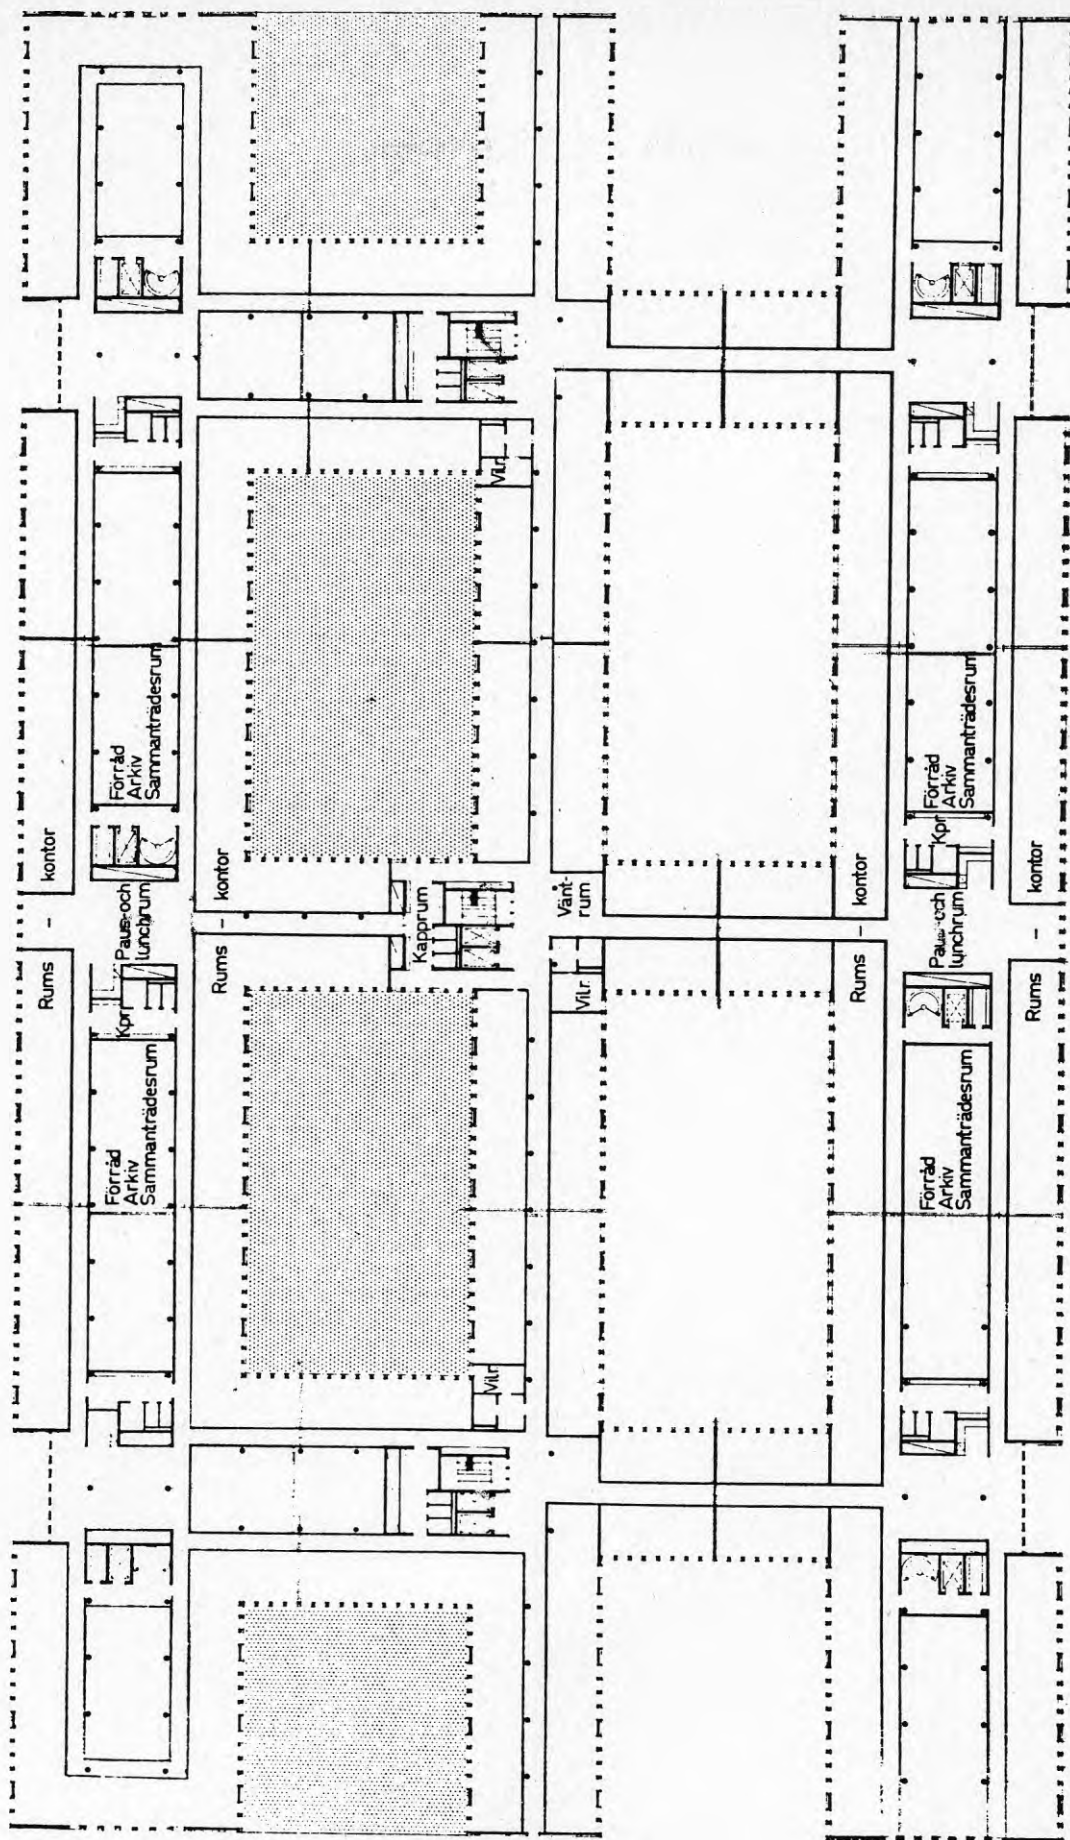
Plan 2-4. Anmälningshandlingar, 1972 sommaren.
